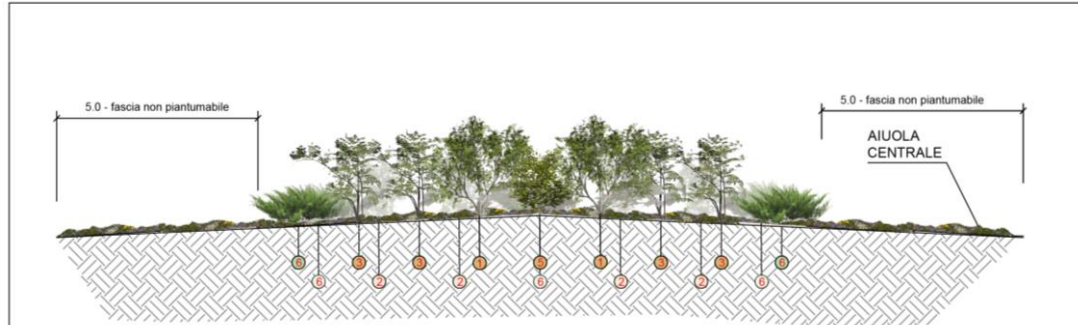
Prospetto piantagione rotatoria modulo PI-RO 2
